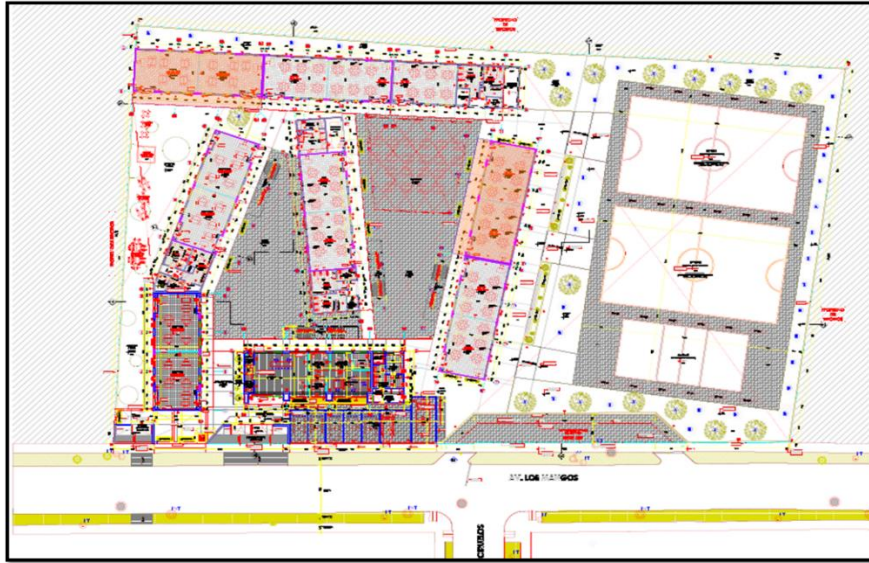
Plano de arquitectura 1er nivel planta. (Fuente Propia).
